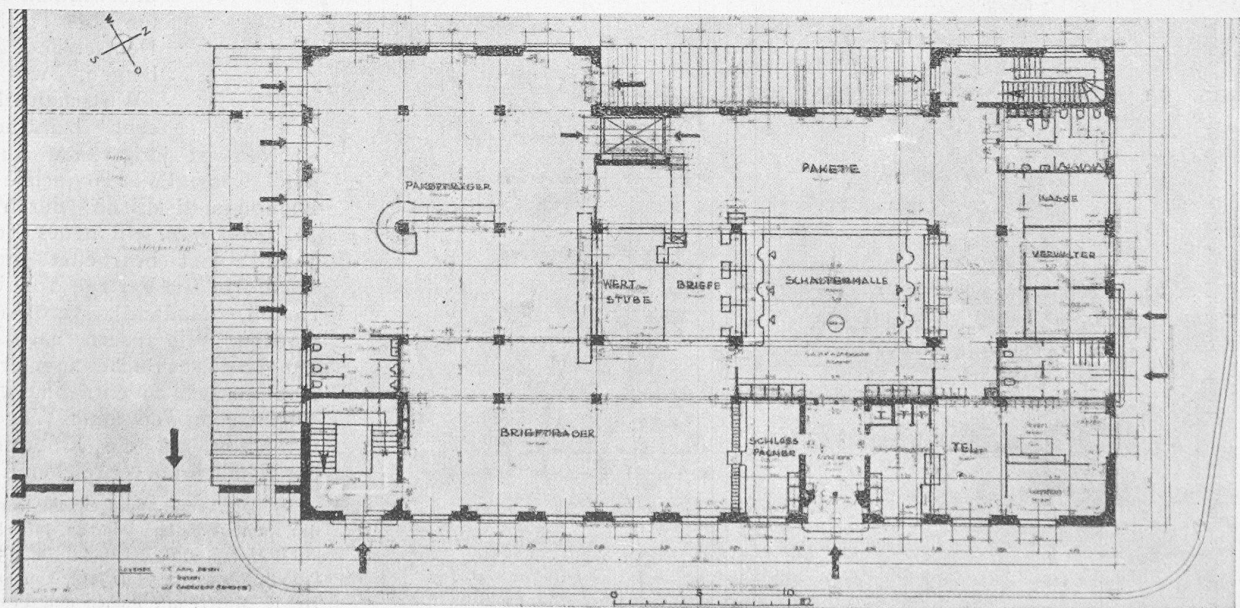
Das neue Postgebäude in Biel. — Grundriss vom Erdgeschoss 1 : 400. — Clichés der Eidg. Baudirektion.
